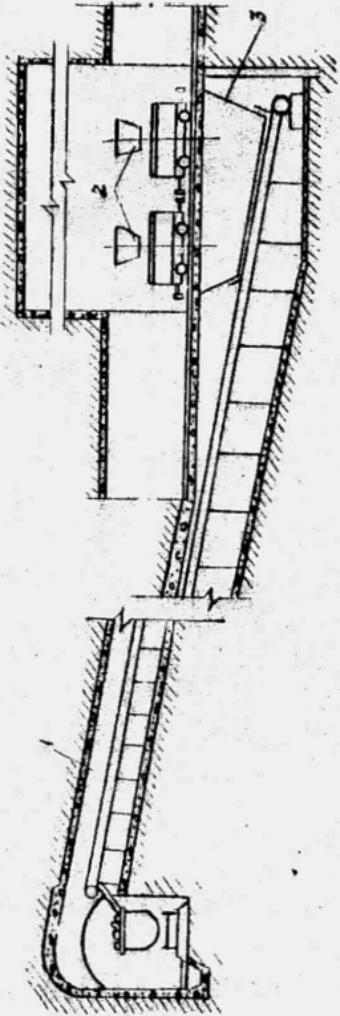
Устройство для уборки прозелей из-под выпускных люков
